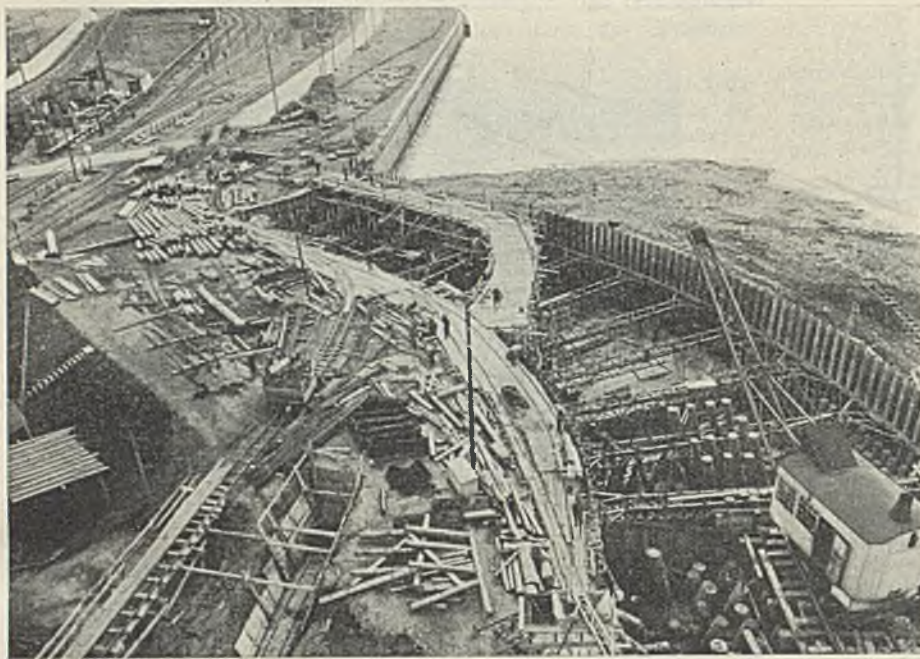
Block 16-17-18 der Kajemauer Außenvorhafen-Ost im Bau, mit eingebauter eiserner Spundwandaussteifung.
